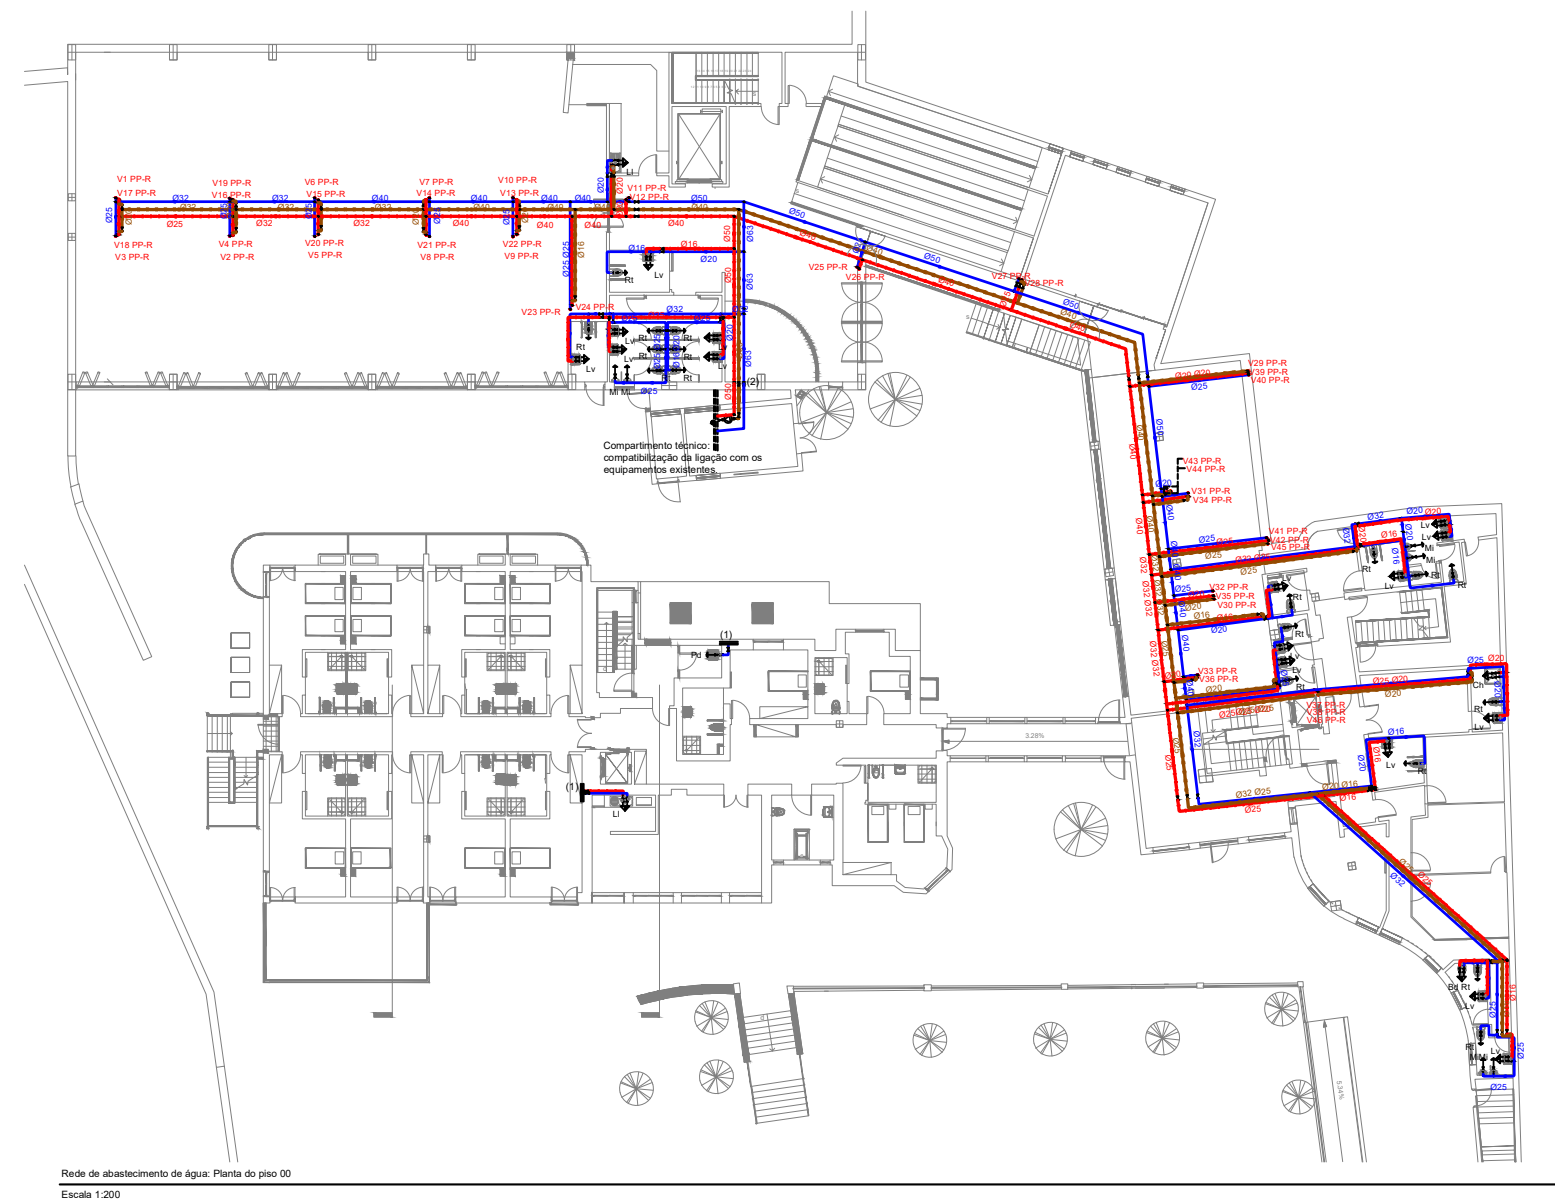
Rede de abastecimento de água potável no edifício em construção - Piso 1 (Esc.1/200)
